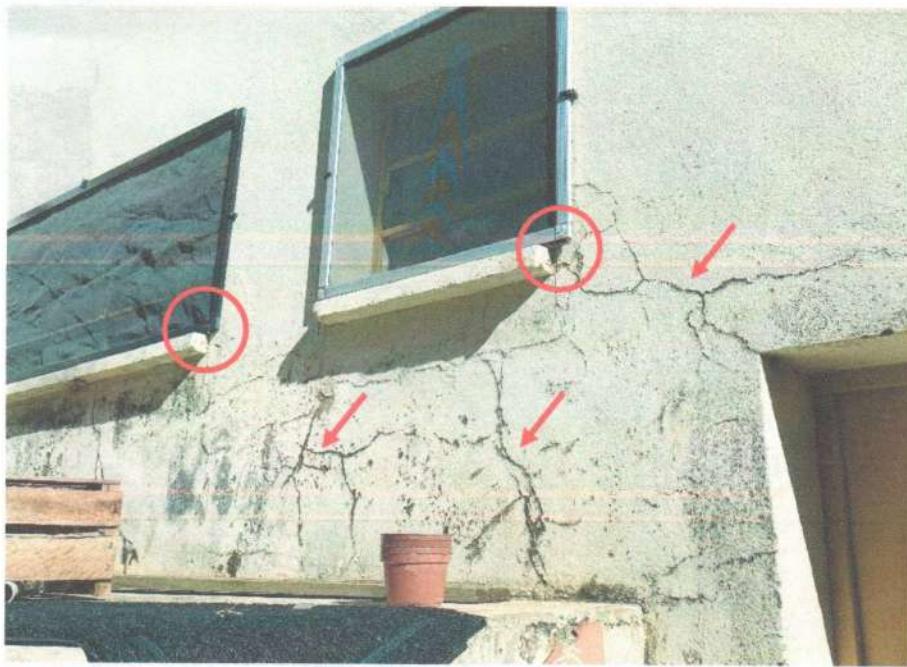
Trincas e/ou fissuras e deficiência nas pingadeiras (Prioridade II, Classificação 3)
